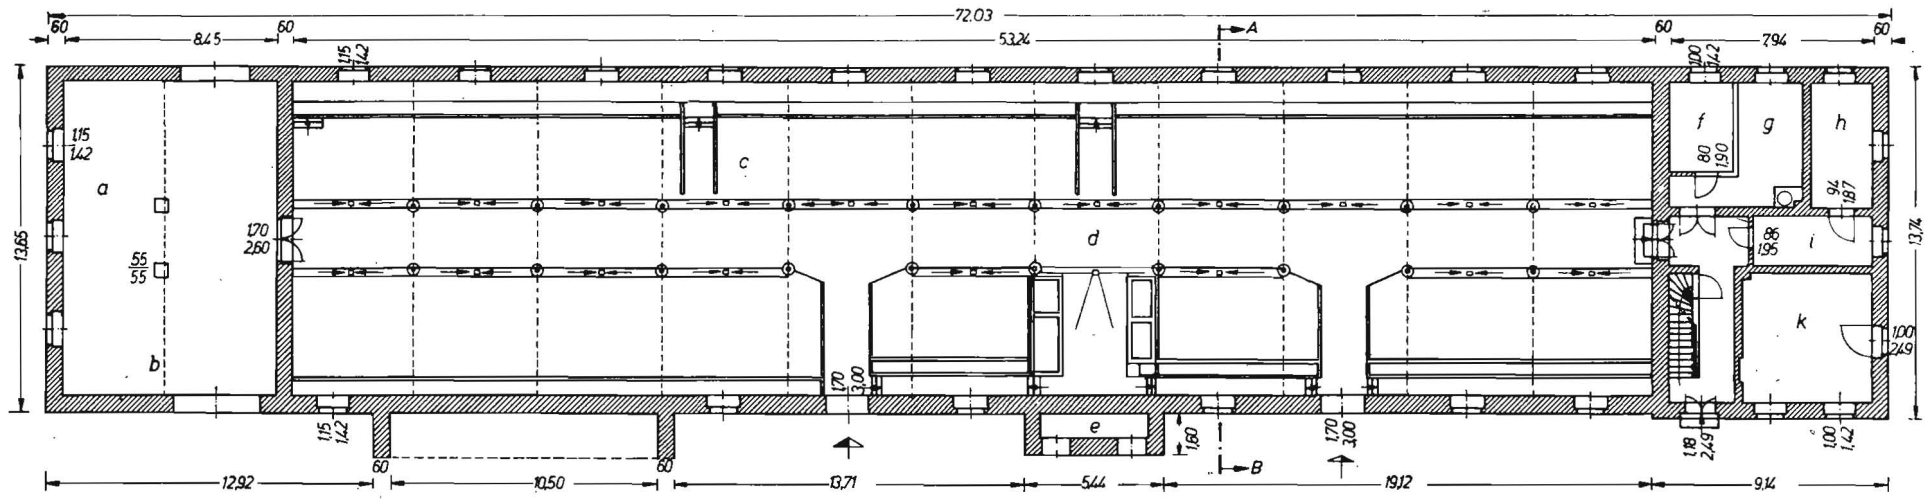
Grundriß des Stallgebäudes vor dem Umbau. a Futterhaus, b I-Träger, c Langstände, d Mistgang, e Schrägaufzug, f Kühlraum, g Spülraum, h Abstellraum, i Abstellraum, k Stellmacherwerkstatt
